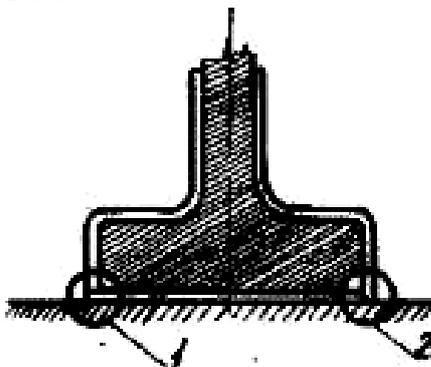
Сопряжение боковых щитов с поддоном:
